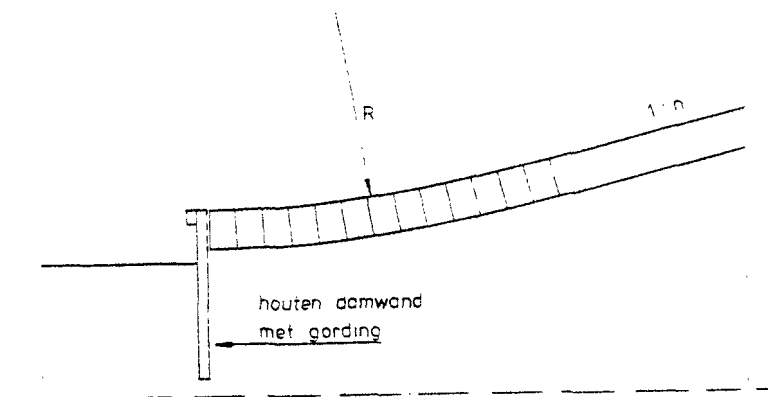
Teenconstructie met houten damwand als mogelijke oplossing bij meerdijken
